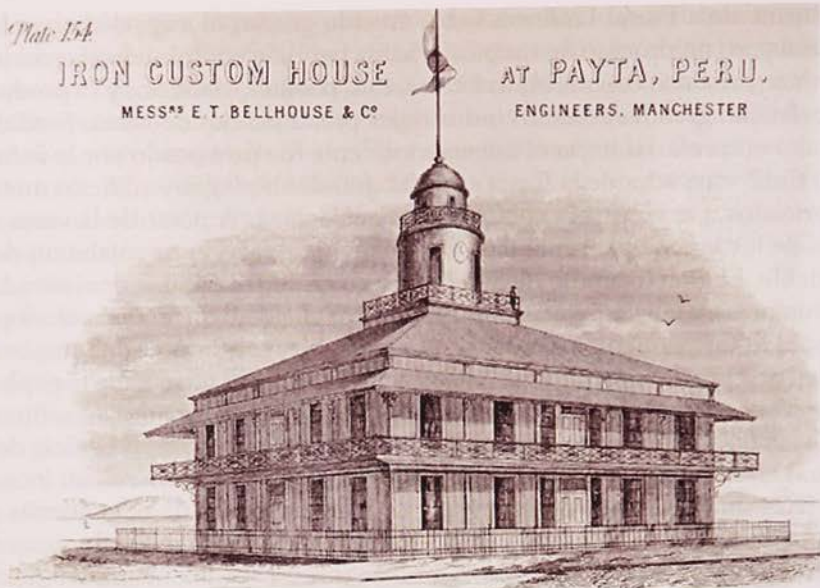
La aduana de Paita construida por la Casa Belhouse de Manchester, también construyeron la aduana ariqueña.
